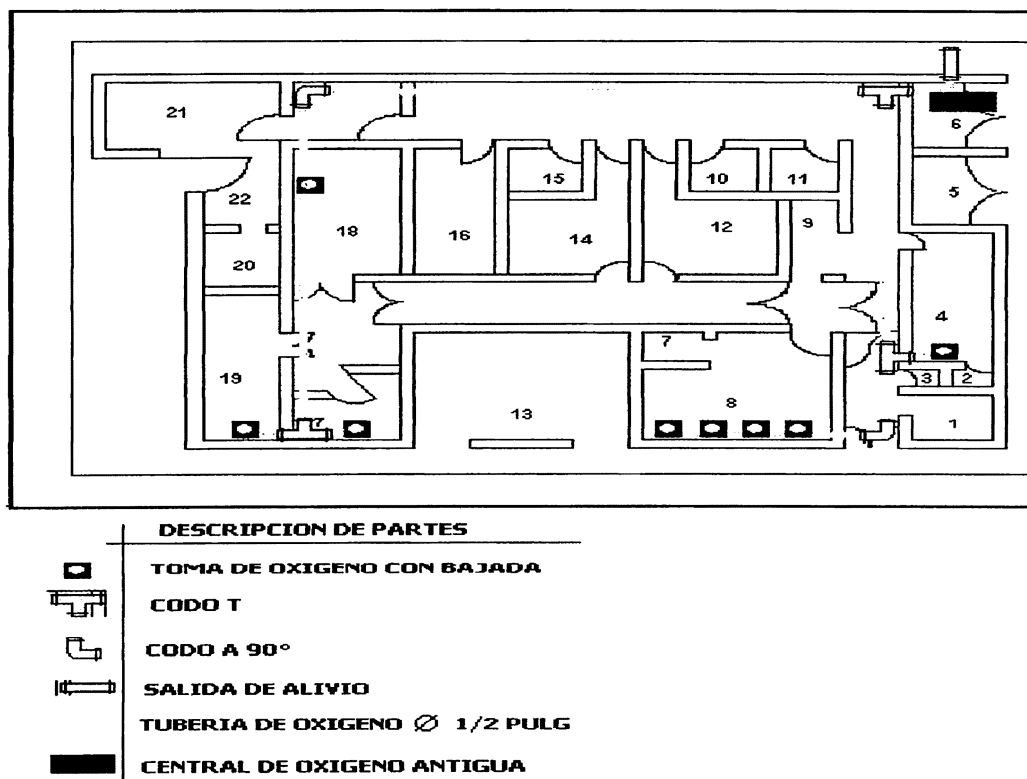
Distribución de tuberías actuales en la planta
